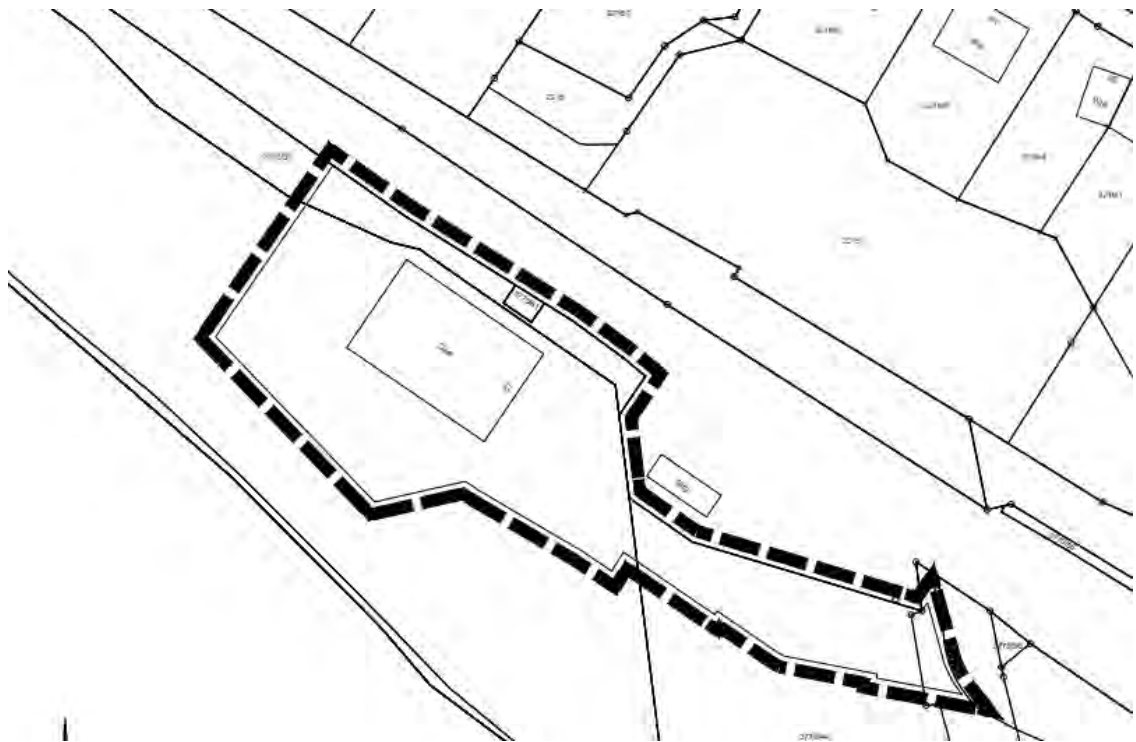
Lageplan mit Geltungsbereich, o.M
